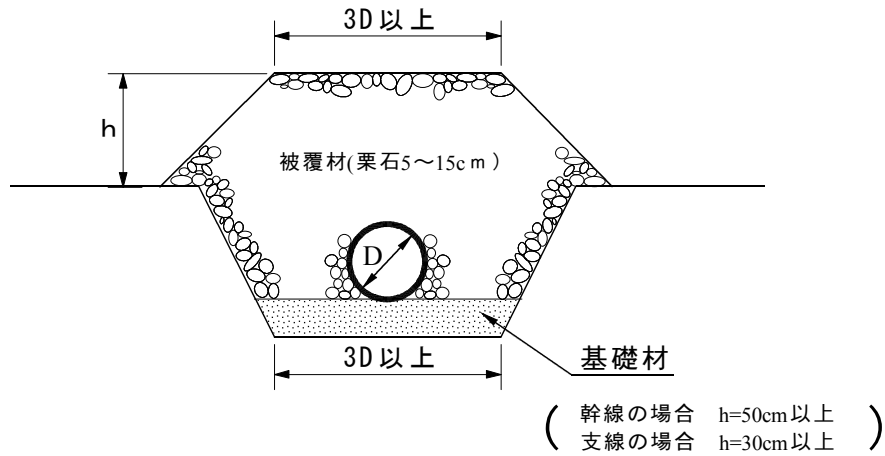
浸透水集排水設備及び地下水集排水設備の構造例 (安定型)
